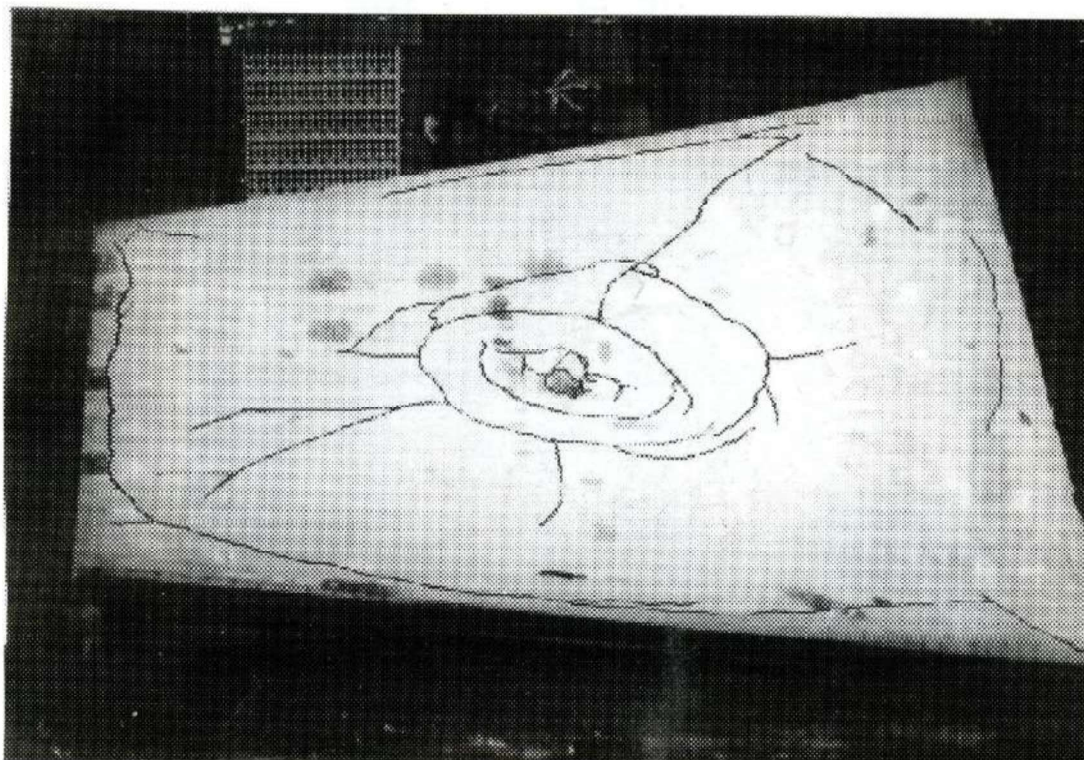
Fissuration - face inférieure, Modèle M30
